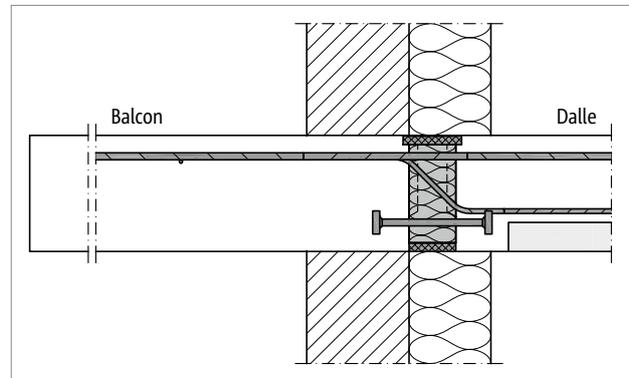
Schöck Rutherma® T type DB : liaison pour balcon en béton dans le cas d'une façade en maçonnerie et plancher constitué de prédalles
